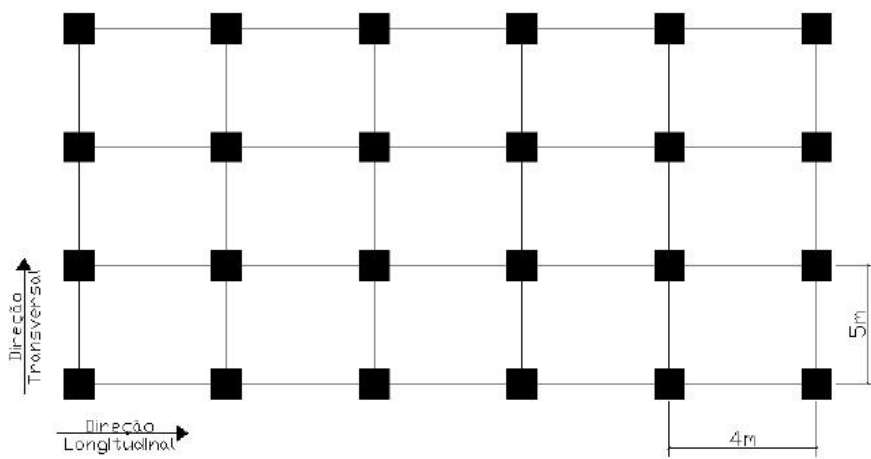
Disposição em planta do Edifício PT4 e indicação dos pórticos estudados (Furtado, 2013).
